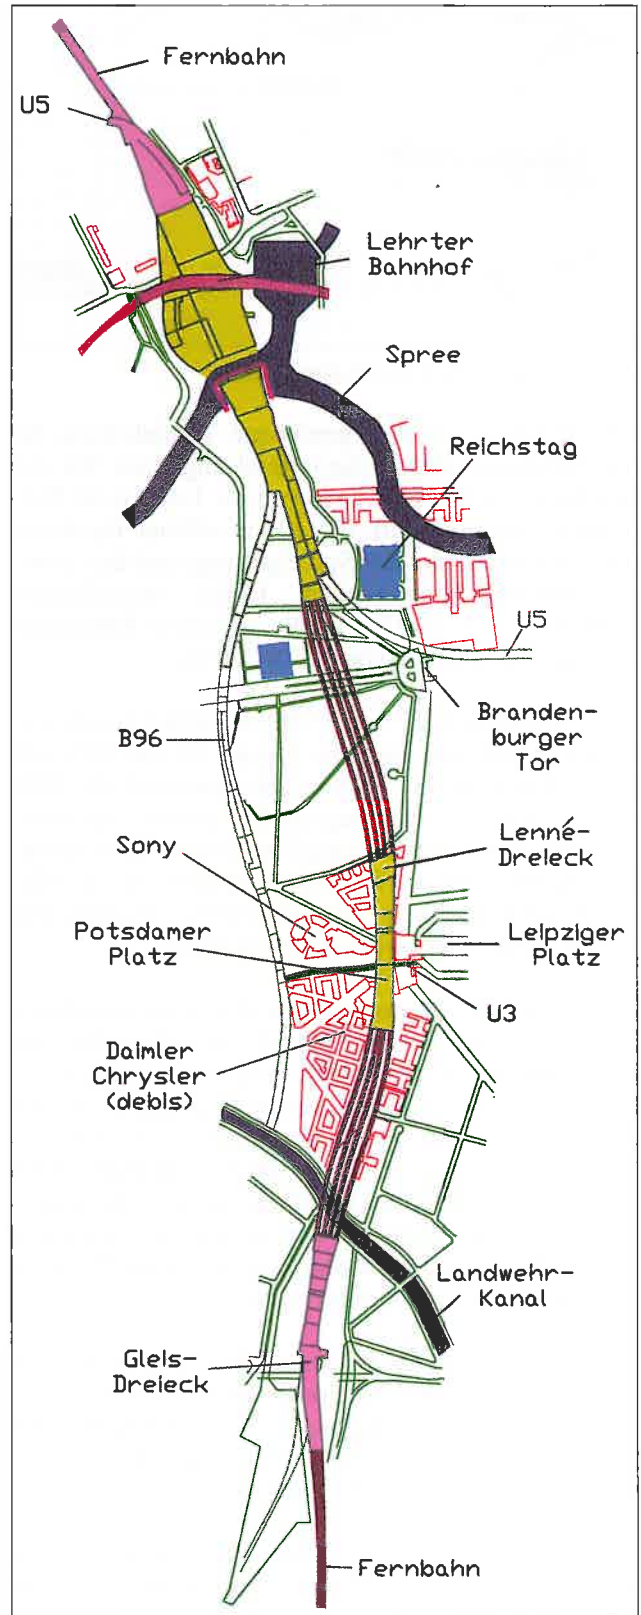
Verkehrsanlagen im Zentralen Bereich, Grundriss
